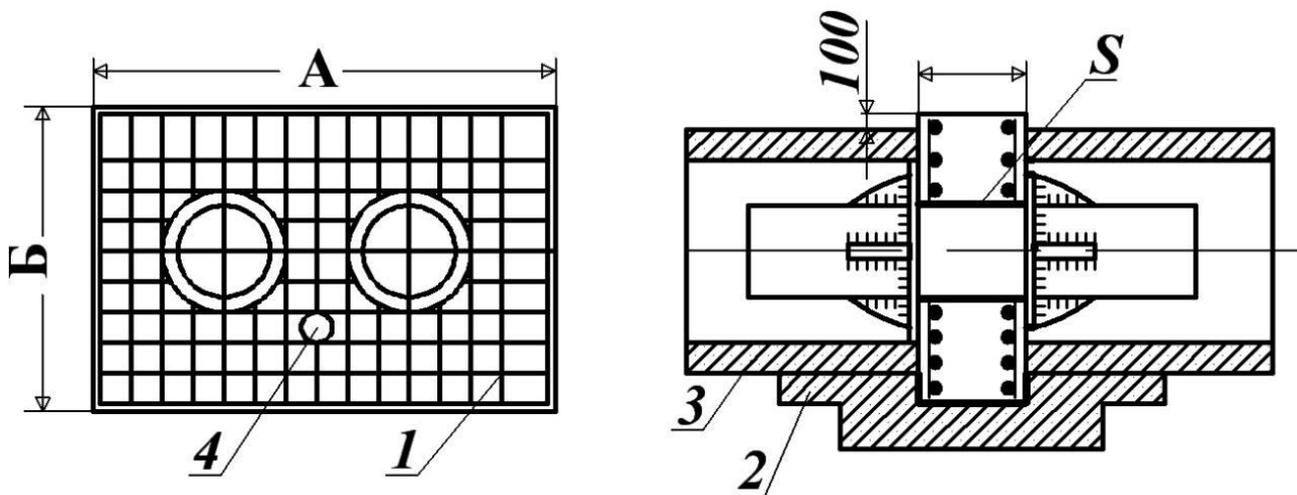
Щитова нерухома опора: 1 – бетон М150; 2 – бетон М75; 3 – днище каналу; 4 – отвір для стоку води; 5 – азбестова прокладка
